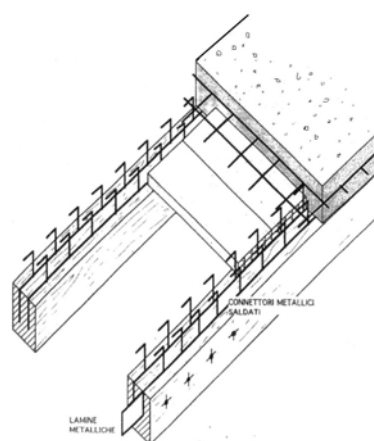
Chapa metálica adherida a la madera con bulones y al hormigón mediante conectadores tipo barra.
